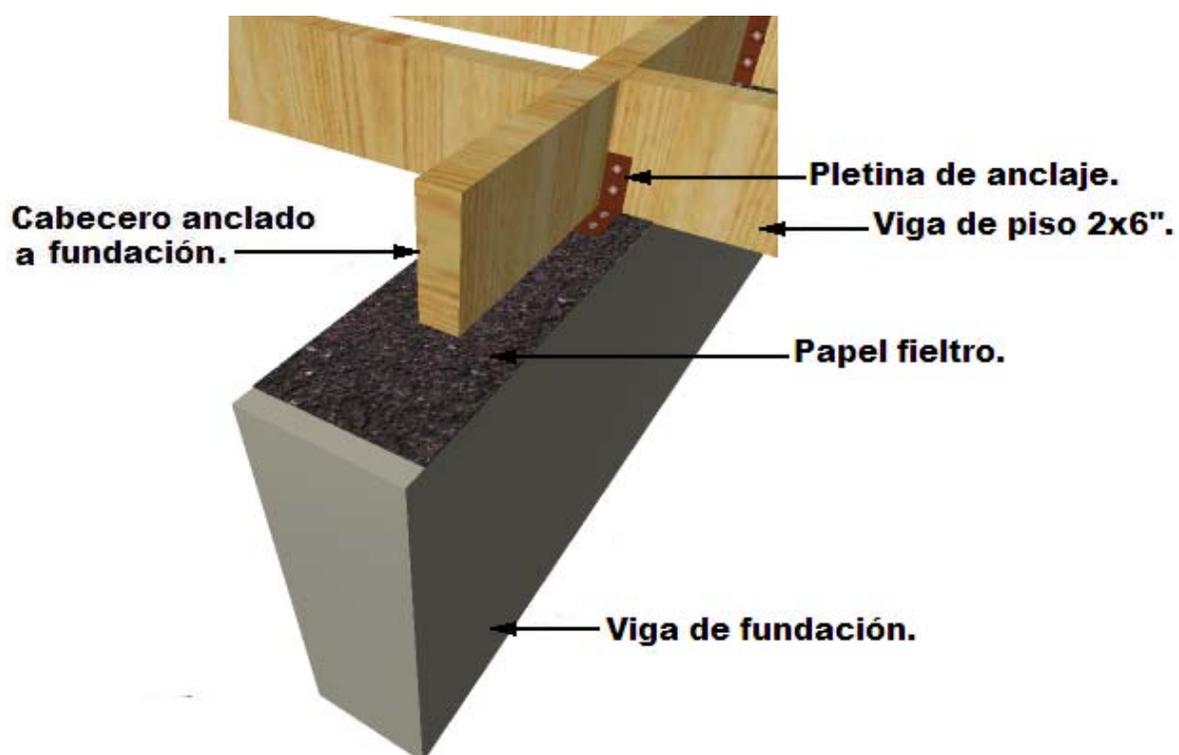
El detalle constructivo indica la forma de sujeción de las vigas de piso para las viviendas del proyecto Elemental del primer nivel. Fuente: Elaboración propia.
